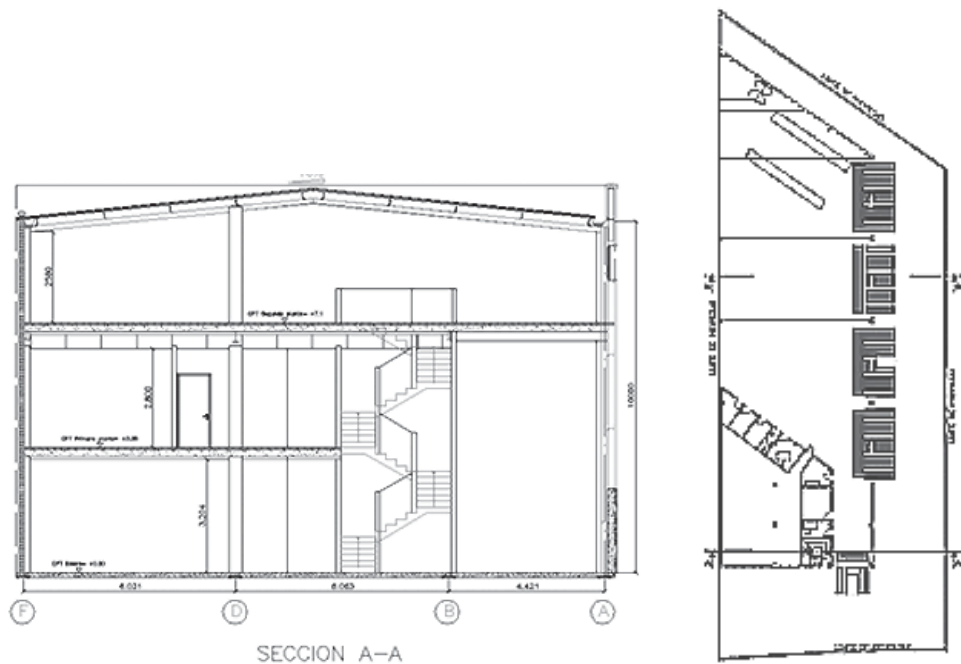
Croquis de corte y planta de la nave industrial de la empresa IVECO.¹⁰
